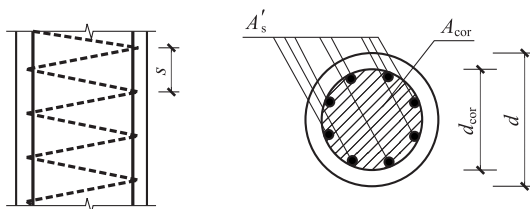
配置螺旋式间接钢筋的钢筋混凝土轴心受压构件
